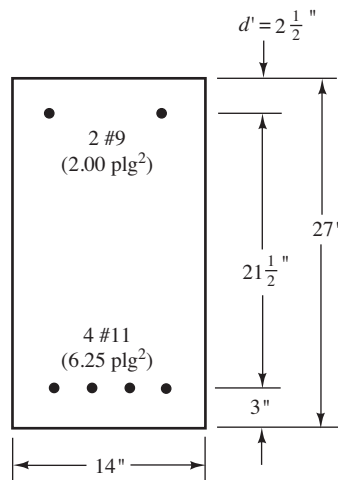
Sección transversal de la viga del Ejemplo 5.7.
